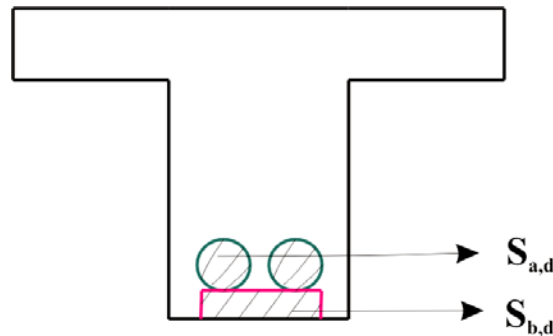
Sections endommagées dans la poutre P_I à mi-portée
